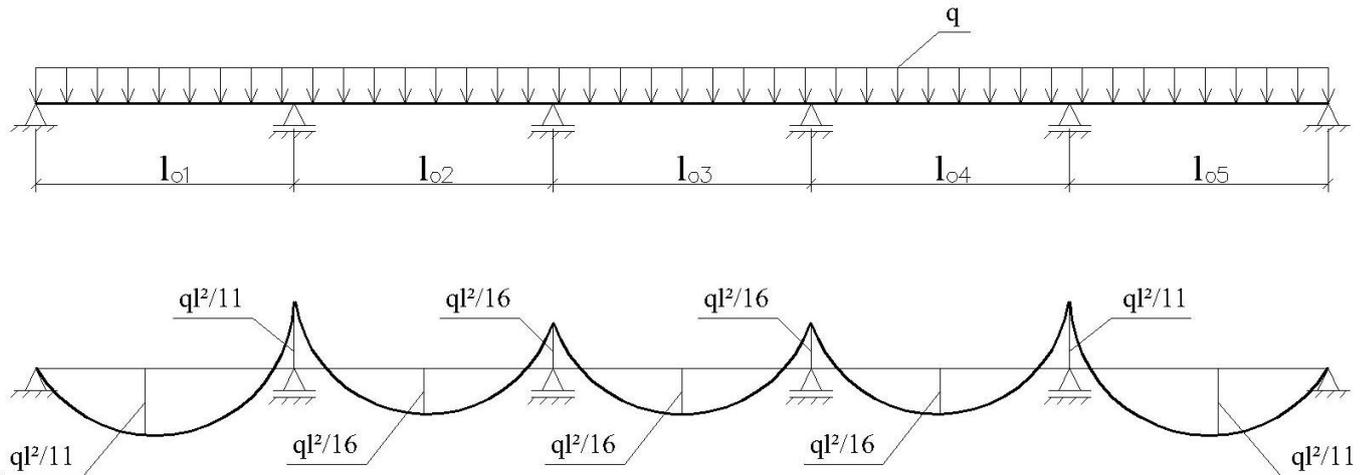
Расчетная схема монолитной плиты перекрытия
